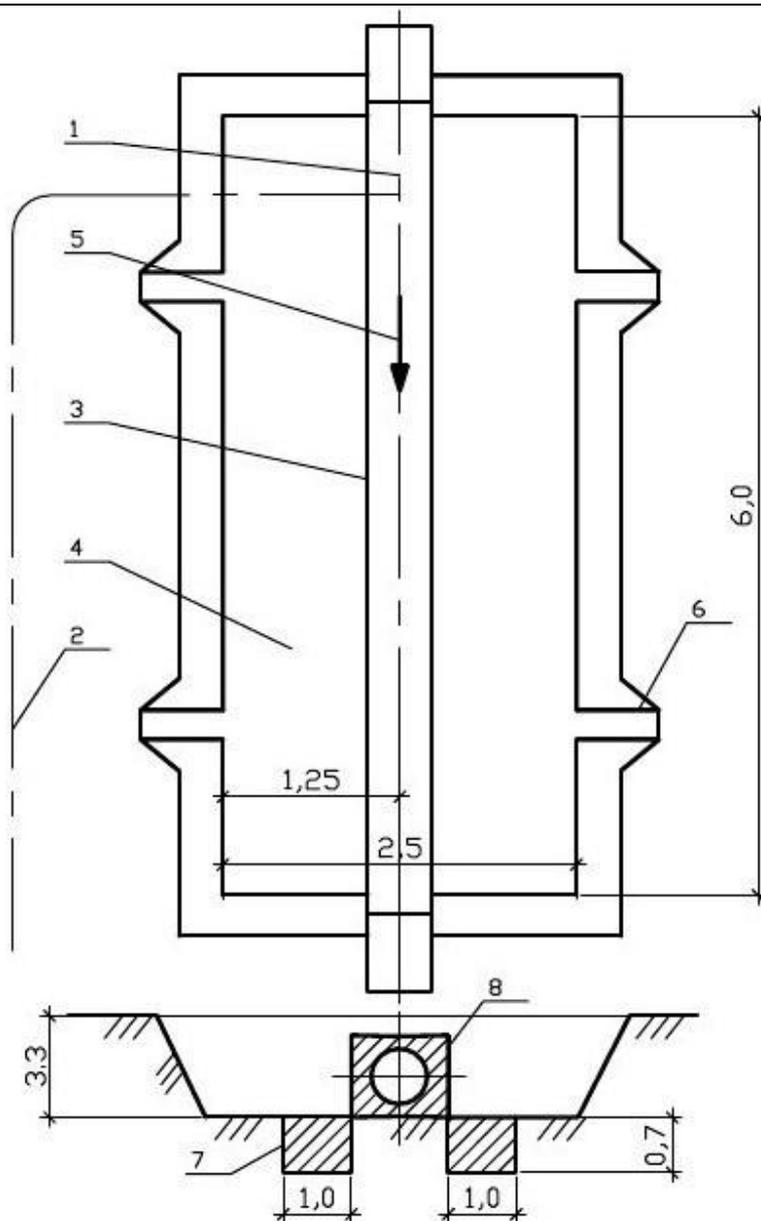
Форма и размеры котлована для проведения работ по врезке и перекрытию конденсатопровода DN 300
